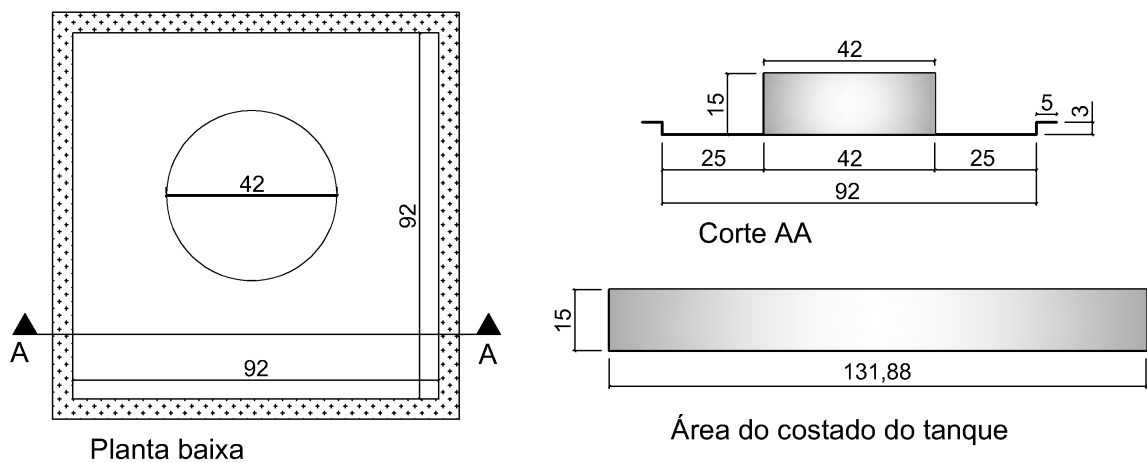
Planta baixa, corte e área do costado de um tanque vertical. Dimensionamento do sistema de espuma.
